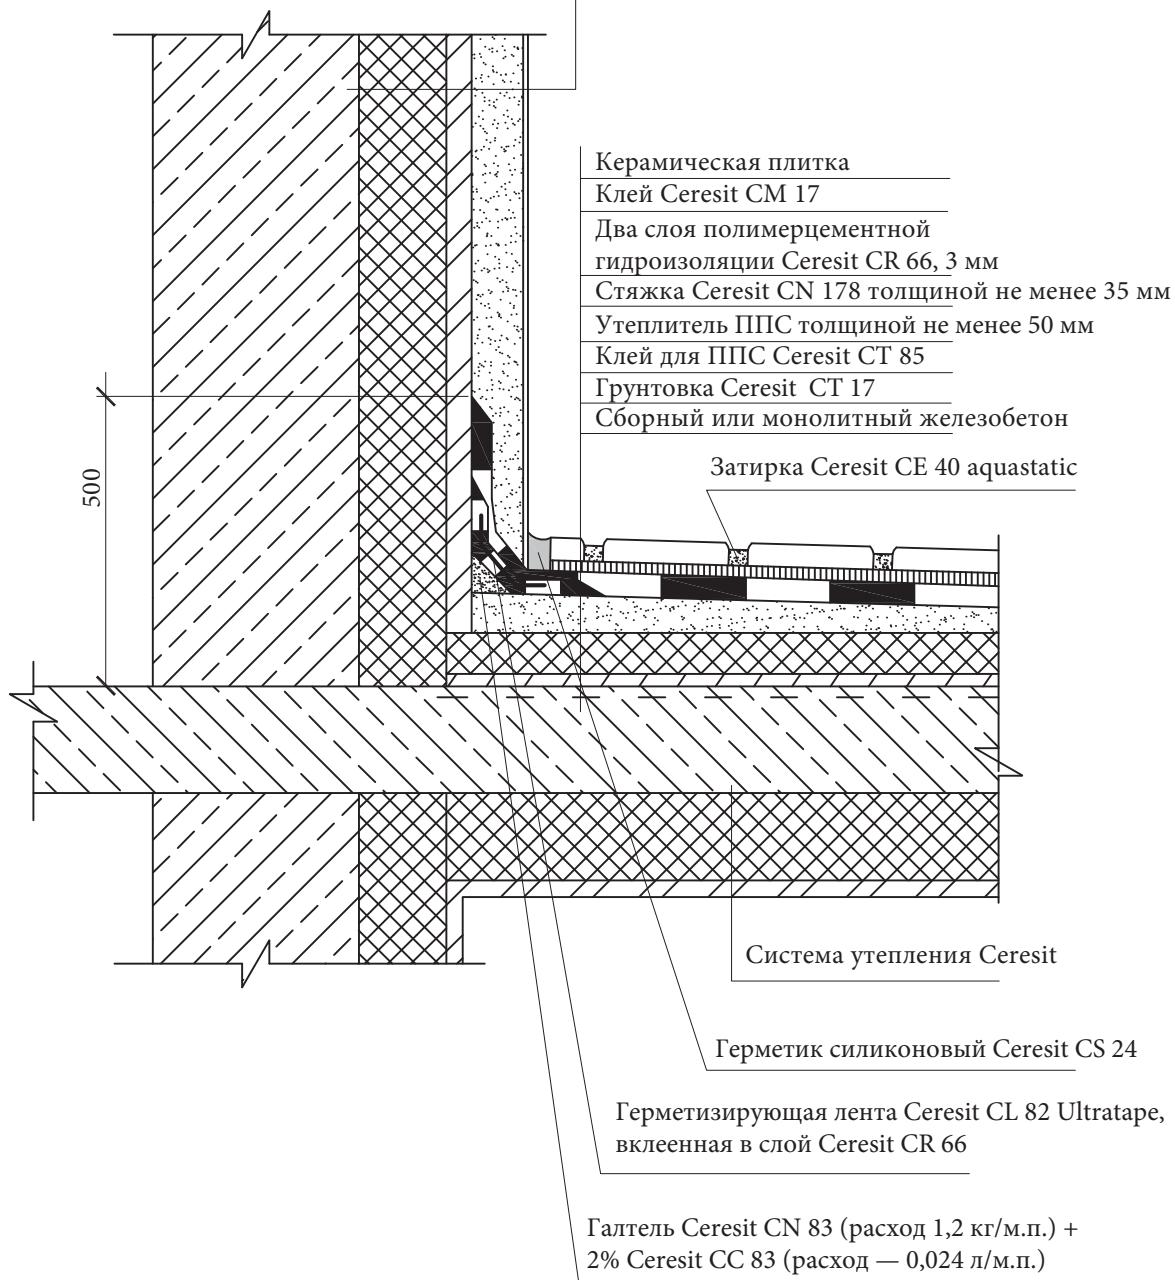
Конструкция гидроизоляции балконов с наружным утеплением
